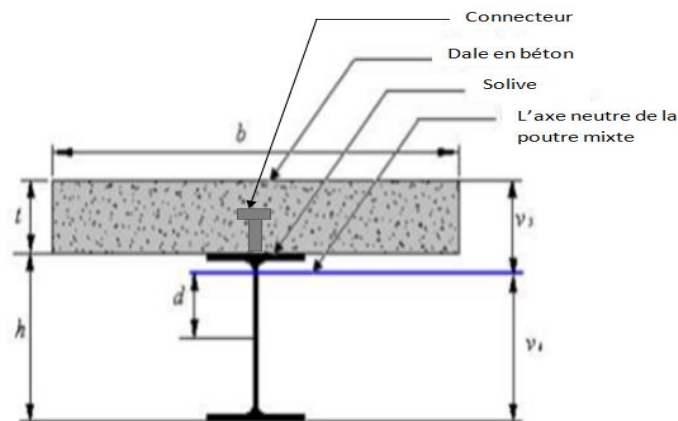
Eléments constructif d'un plancher collaborant.
